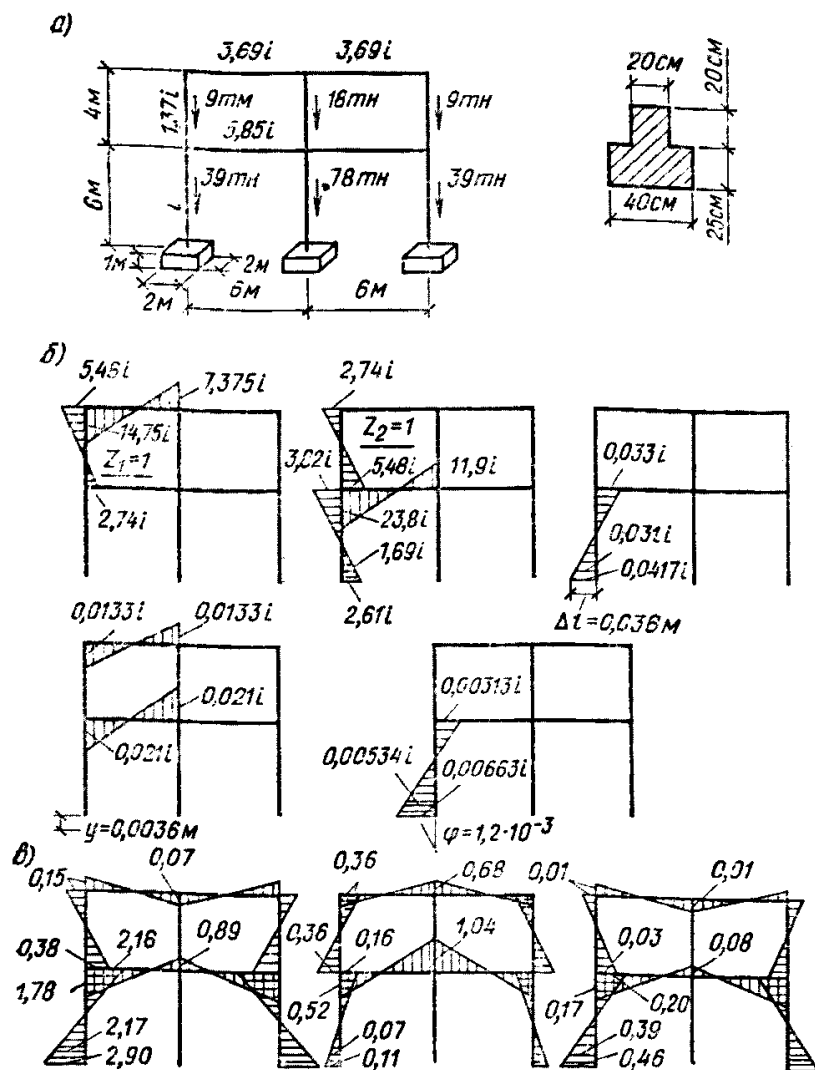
Пример расчета многоэтажной железобетонной рамы
